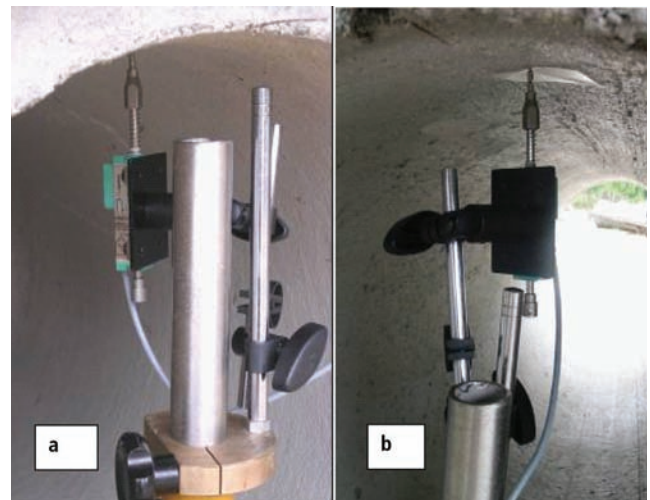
(a) detalhe do suporte para posicionamento do LVDT para leitura da deformação do tubo de concreto durante o ensaio de compressão diametral e (b) da folha de acetato que evitava a entrada da agulha em uma possível fissura.
